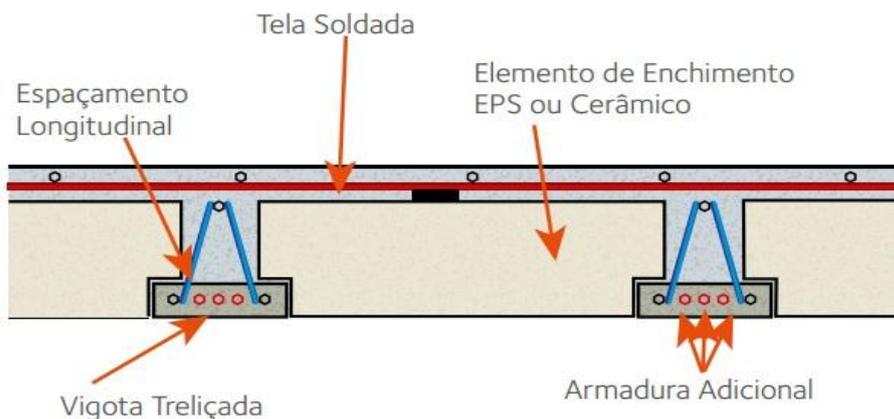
Corte transversal pré-laje treliçada com elemento de enchimento
